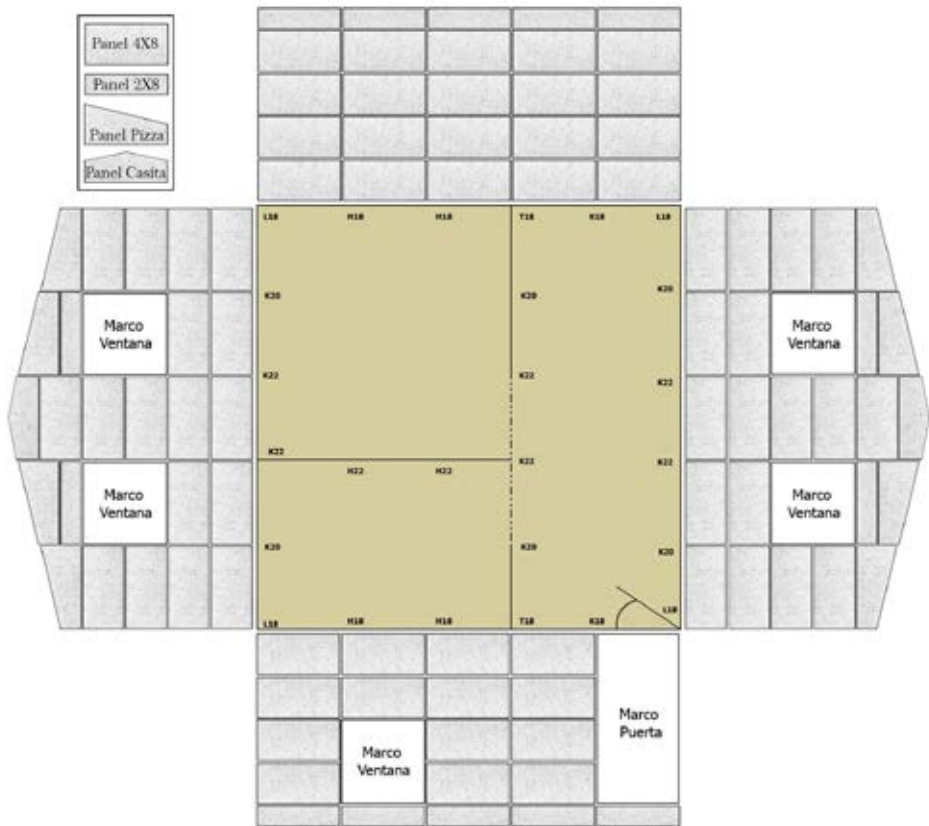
Tipos de piezas y disposición (dibujo de César Fernández, 2018).
